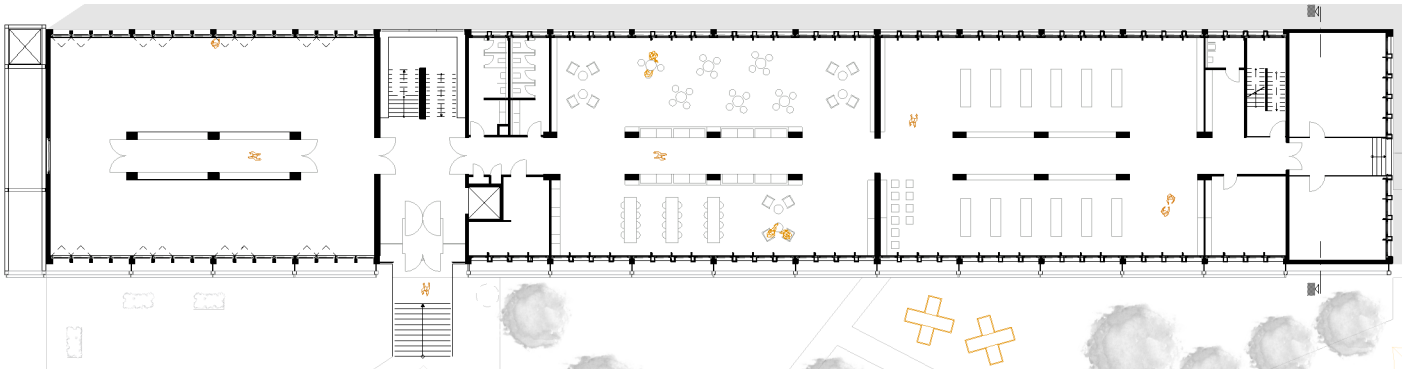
Grundriss Erdgeschoss – Bestand 1:500
